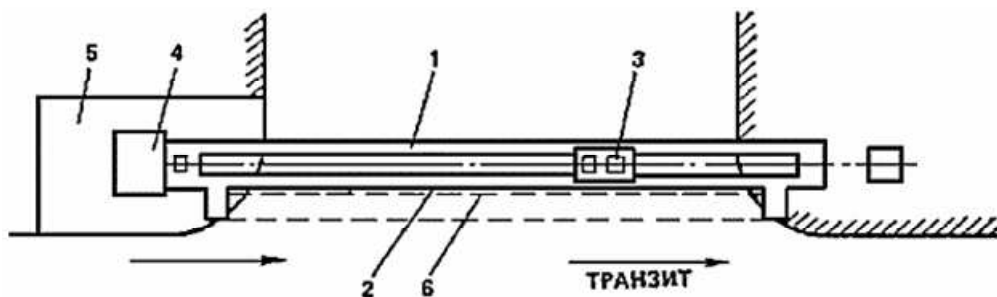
Схема расположения конструкции РЗУ типа плоской сетки:
